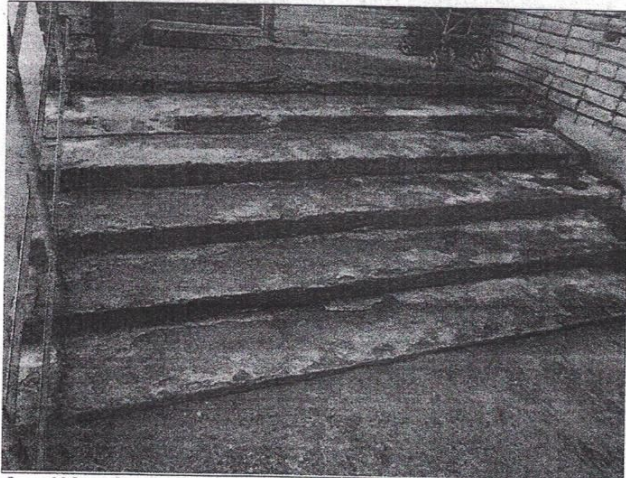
Отдельный вход в группу расположенную на первом этаже. Наружная лестница
